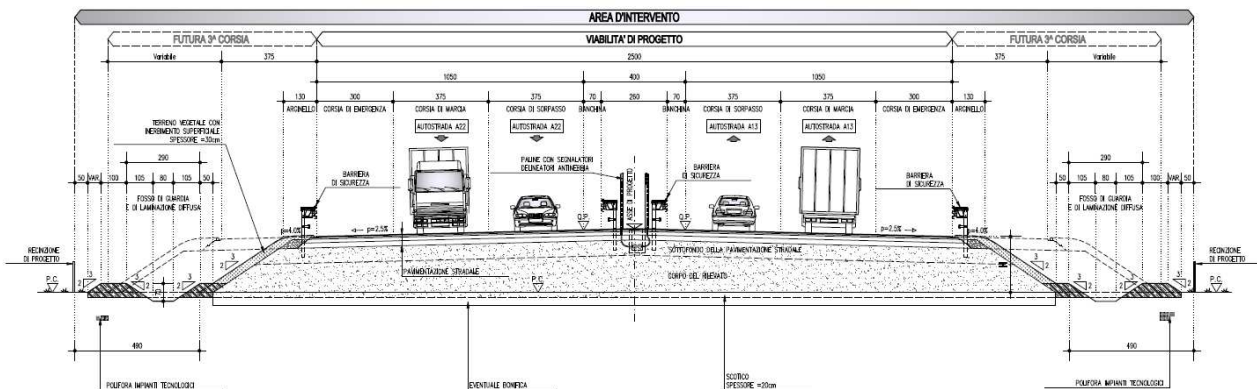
SEZIONE TIPO ASSE AUTOSTRADALE IN RETTIFILLO
